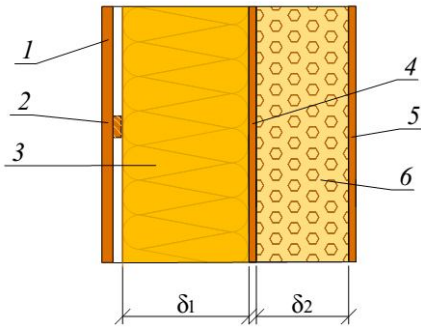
Стена из газобетонных блоков с облицовкой доской: 1, 4 – обшивка; 2 – 20 мм вентилируемого слоя; 3 – тепловая изоляция; 5 – штукатурка; 6 – кладка из газобетонных блоков
